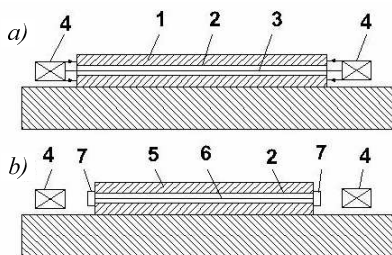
Схема натягу арматури на бетон: *а* – бетон затвердів; арматура натягнута одночасно з обтиском бетону; *б* – бетон обтиснутий, арматура закріплена;
